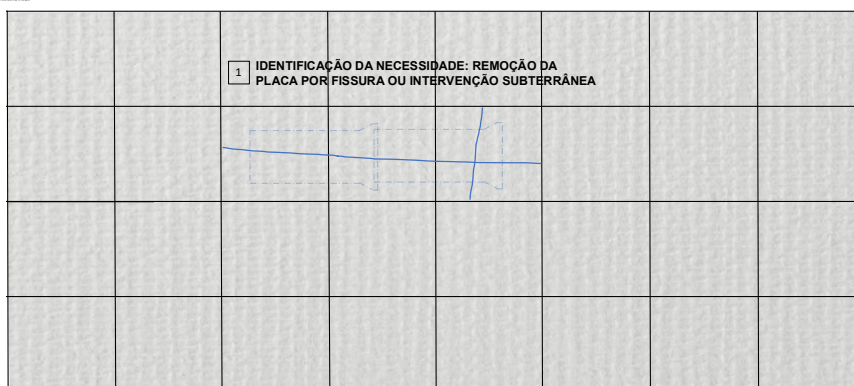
Identificação da necessidade: remoção da placa por fissura ou intervenção subterrânea.
